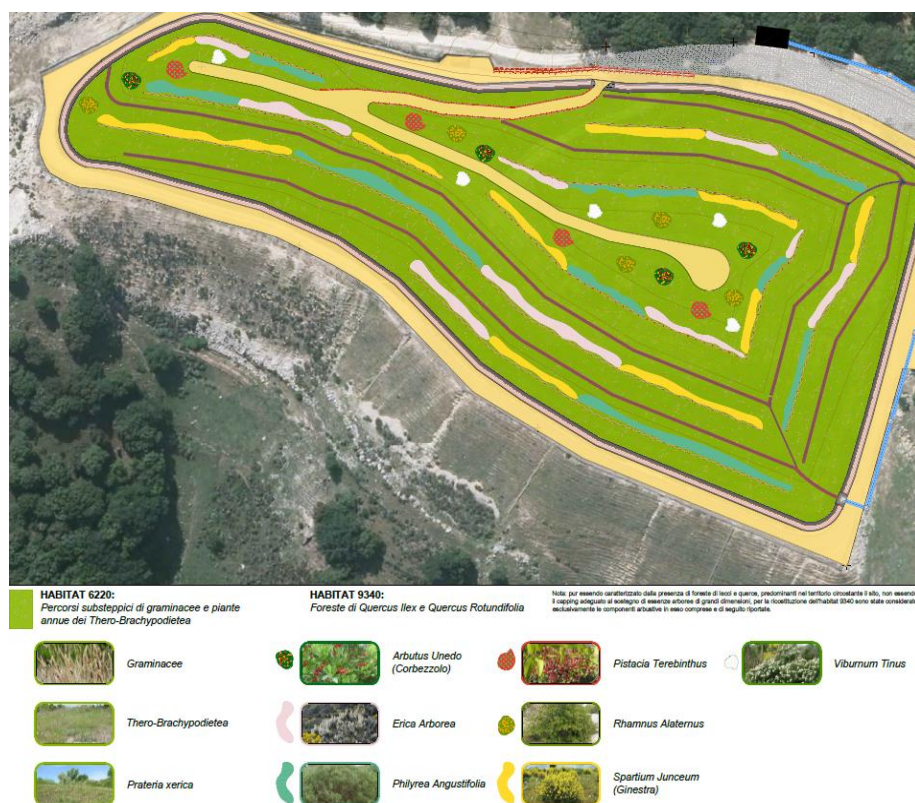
planimetria delle piantumazioni e sistemazioni finali
